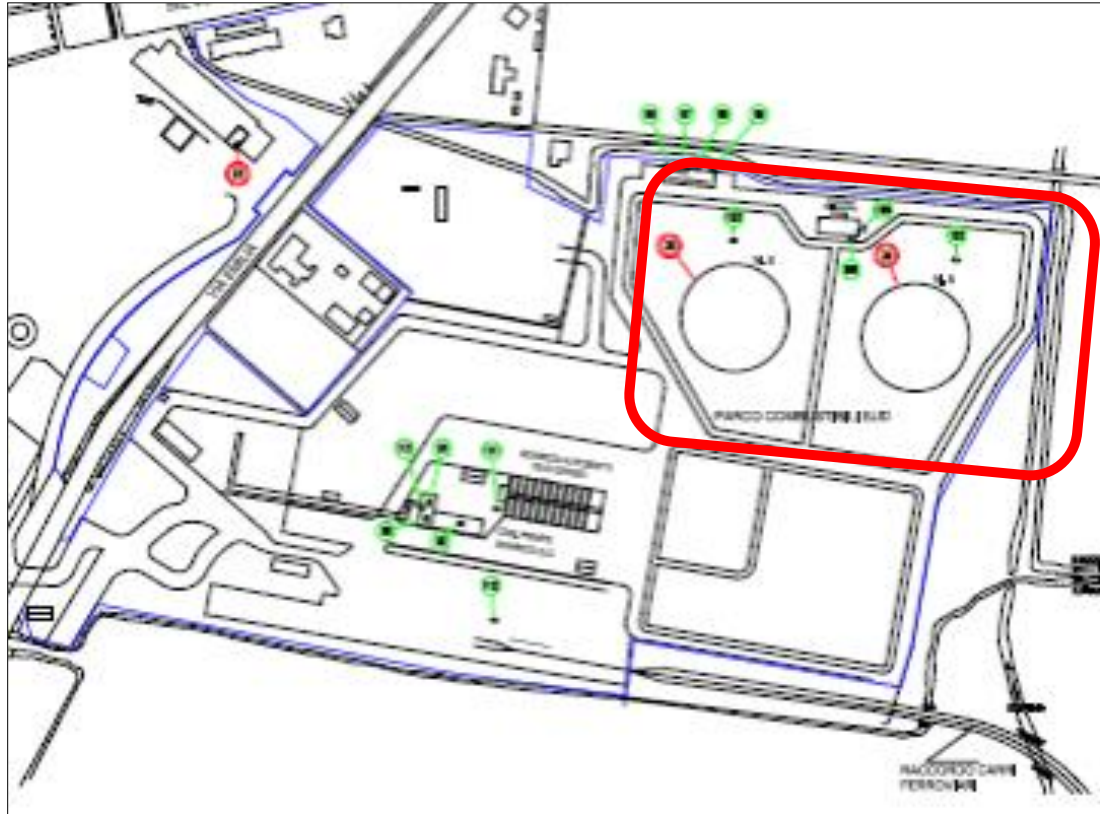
Pianta schematica delle aree d'intervento nel Parco Sud – FASE 2.
